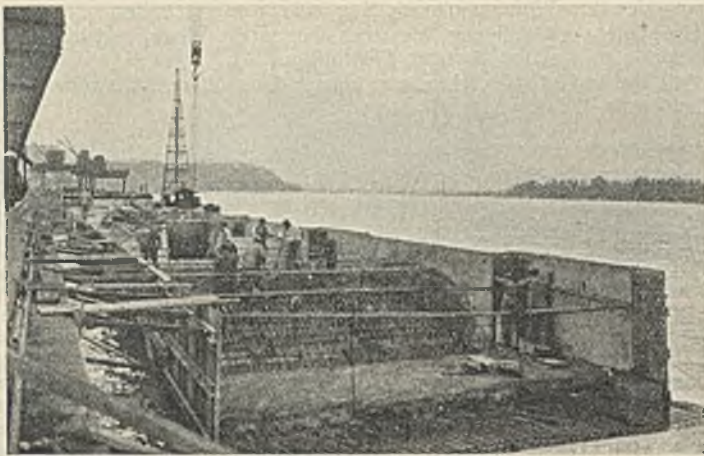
Verlegung der Eisenbewehrung und Betonierung der Gewölbe.
